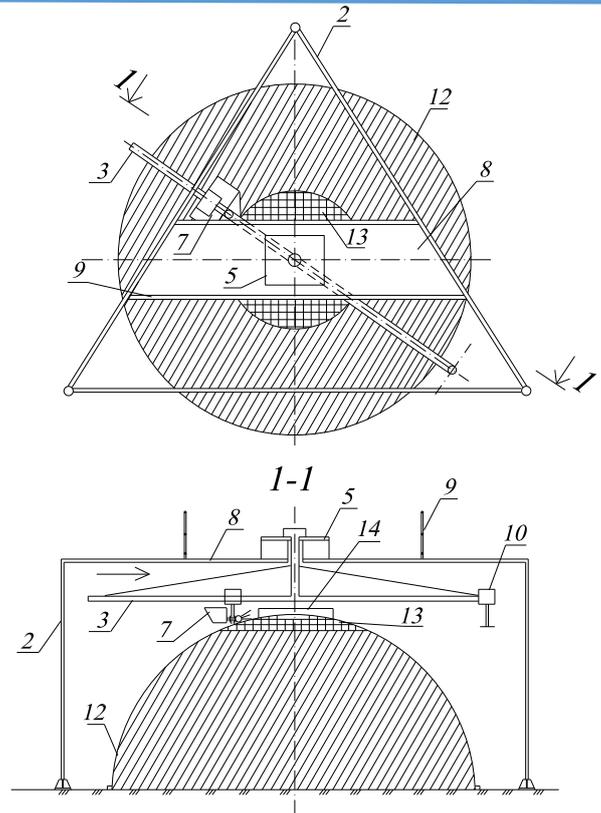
Армирование потолочной части купола и устройство опалубки верхнего опорного кольца: 1- опалубка купола; 2- рама; 3- консоль; 4- телескопические стойки; 5- механизм вращения консоли; 6- арматурная бухта; 7- торкрет-установка; 8- рабочий настил; 9- ограждение; 10- механизм подъема; 11- арматура; 12 – бетон оболочки купола; 13- арматурная сетка; 14- опалубка верхнего опорного кольца
